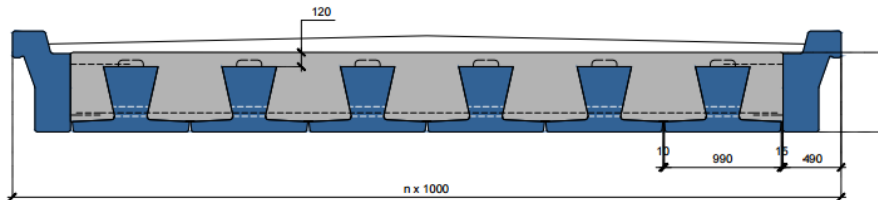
Bjelkebrokonseptet «Box girder beams» fra Stanton Bonna [38]
